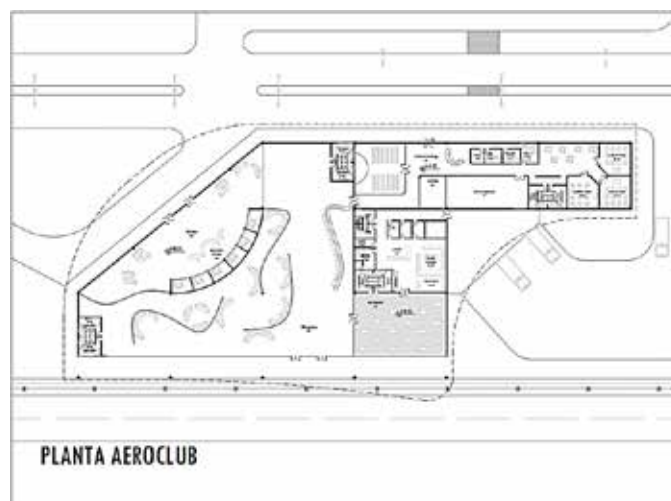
Planta baja edificación aeroclub. Fuente: Sosa (2020)
